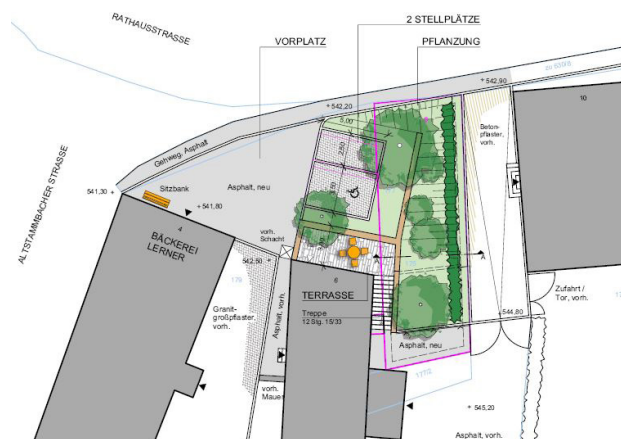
FONOB-Maßnahme Rathausstraße 8
